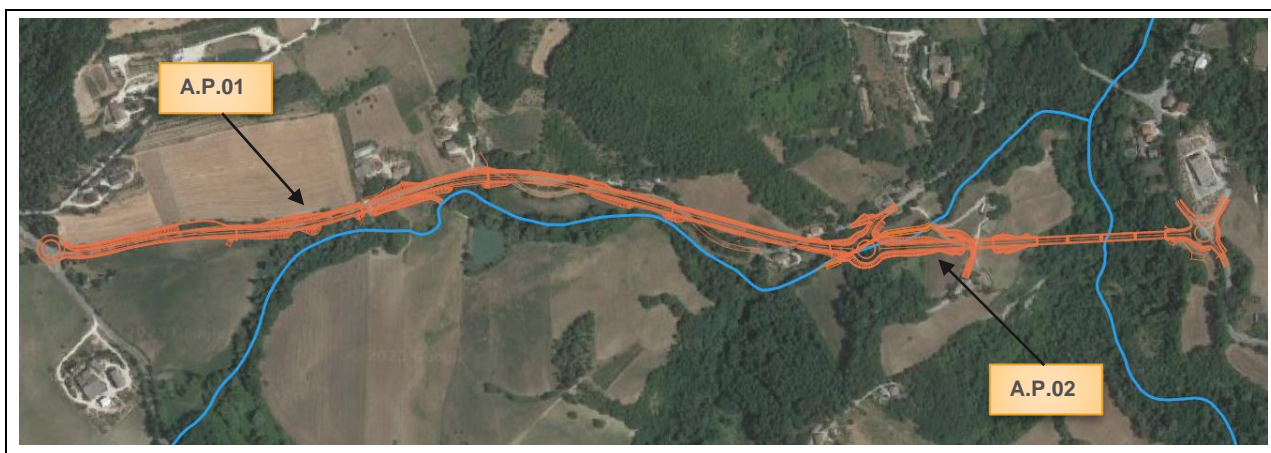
Stralcio planimetrico della nuova viabilità in progetto
